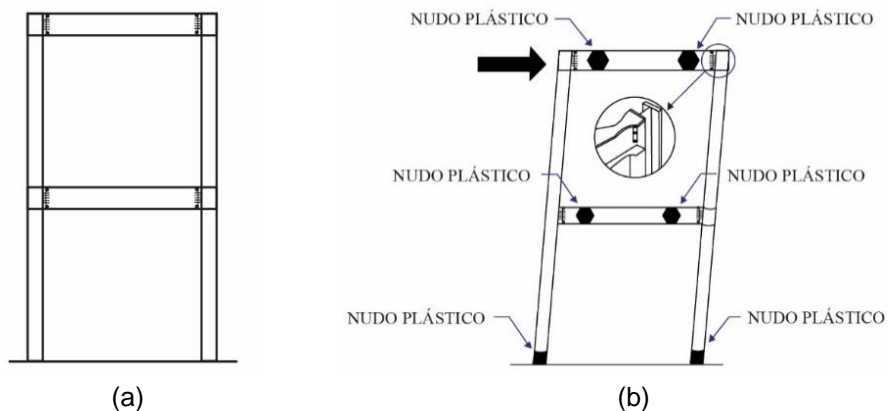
a) Estructura sin deformar con conexión rígida; b) Estructura deformada.
